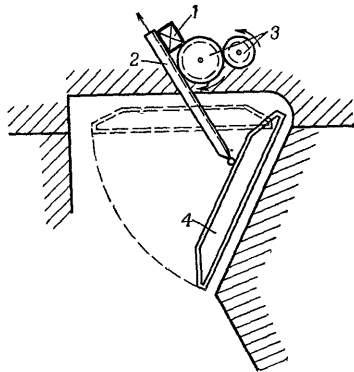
Подрывание поворотного механизма шлюзовых ворот:
